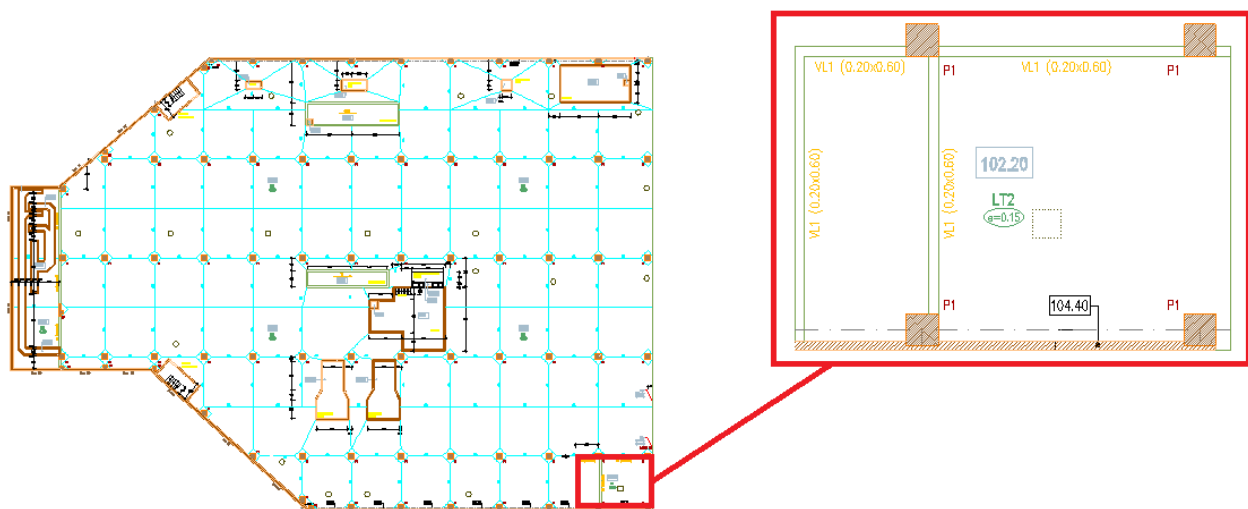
Planta do pavimento têrreo: A vermelho, o local com a solução LT2; o restante recorre à solução LT1.
